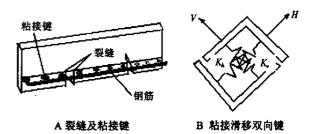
最初的钢筋混凝土梁 有限单元分析中连接键
